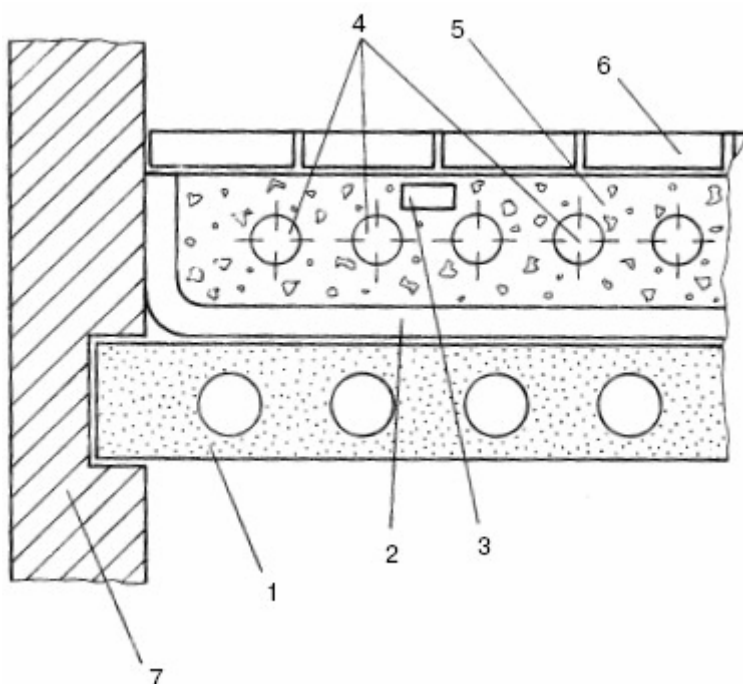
Нагревательный кабель в бетонной стяжке по теплоизоляции: 1 – перекрытие; 2 – теплоизоляция; 3 – датчик температуры; 4 – нагревательный кабель; 5 – бетонная стяжка; 6 – напольное покрытие; 7 – несущая стена
